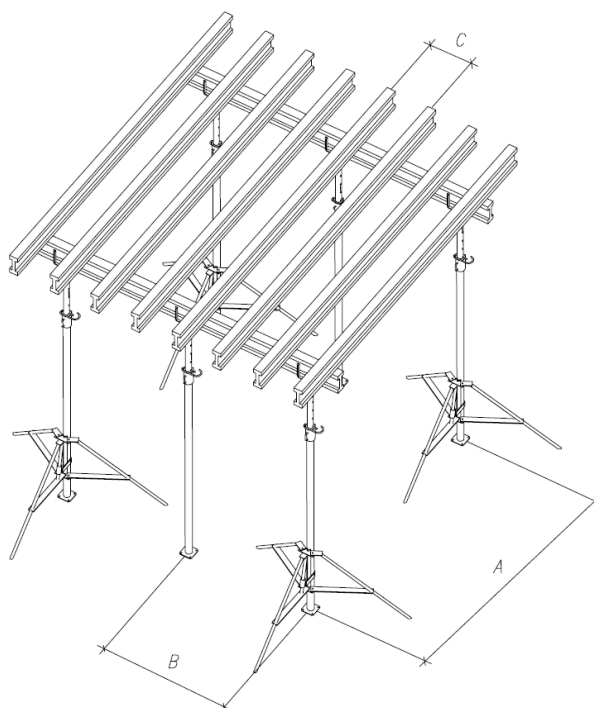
Схема расстановки телескопических стоек и раскладки деревянных балок опалубки перекрытий
